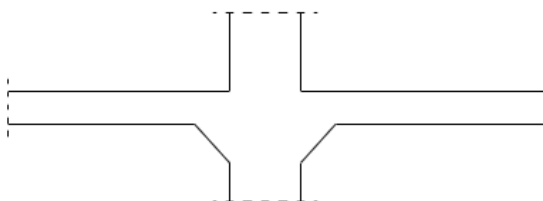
Laje fungiforme maciça com capitéis de espessura constante [6]
